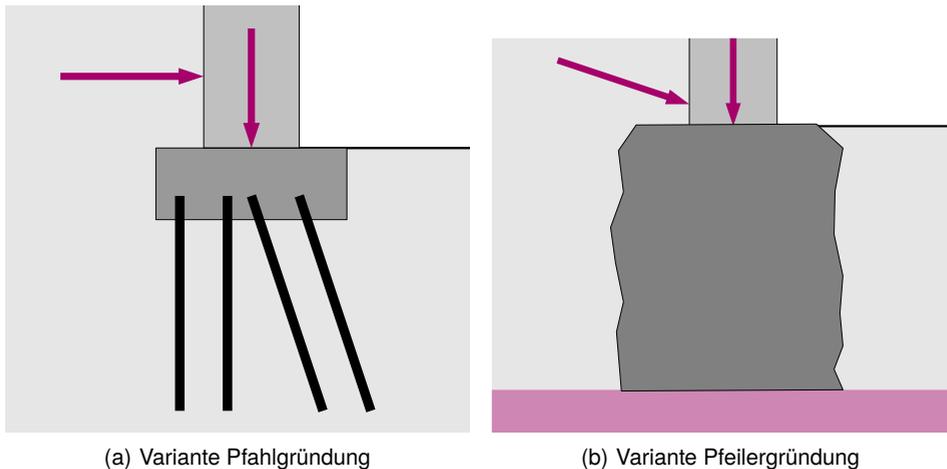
Varianten der Gründung des Brückenwiderlagers bei wenig tragfähigem Untergrund
